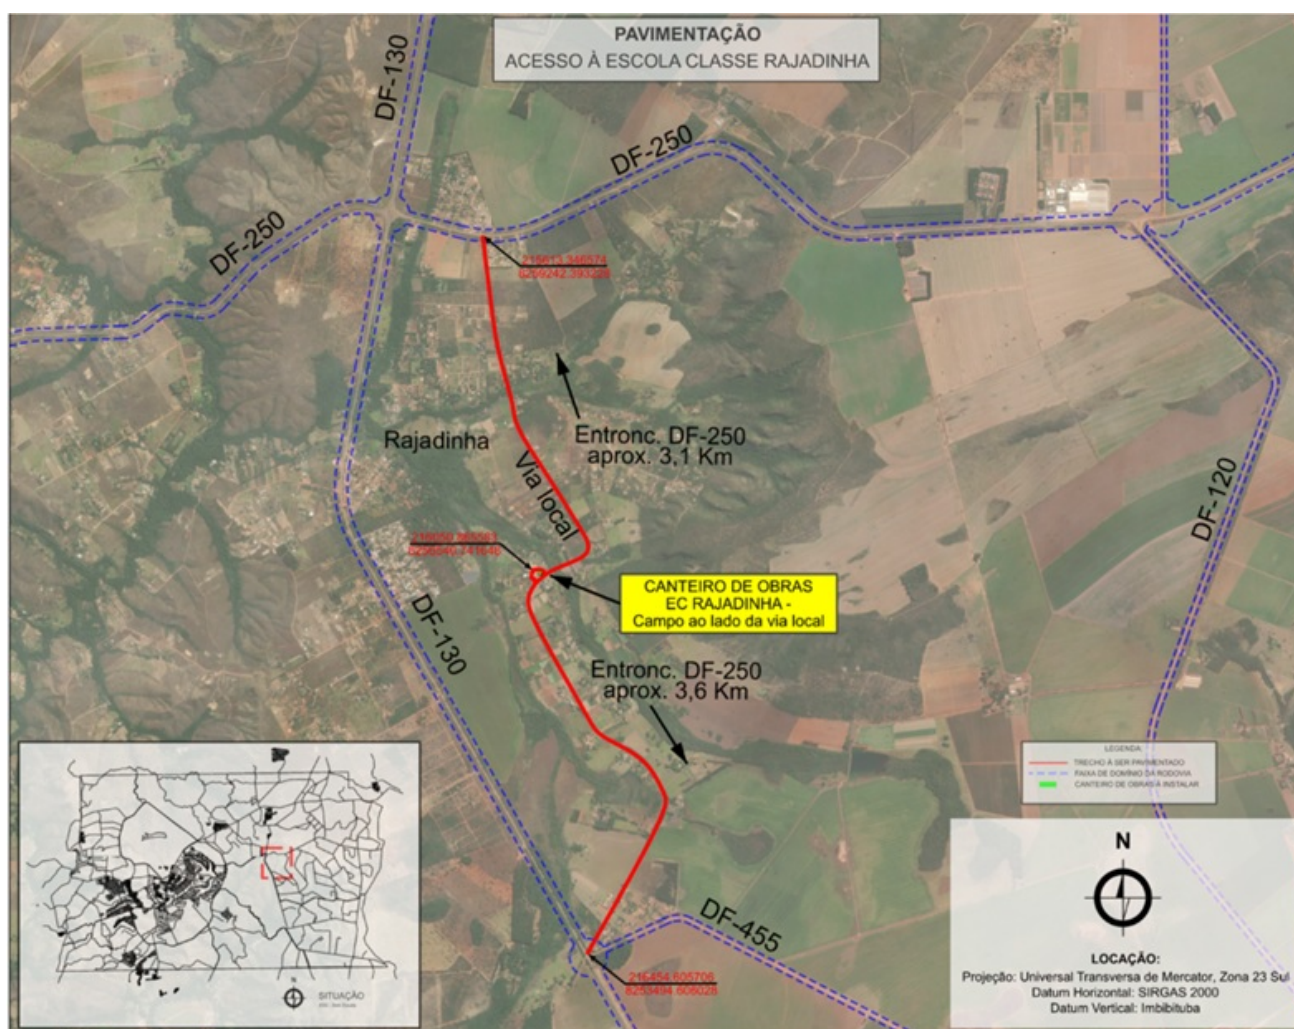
Pavimentação da Via Local (Escola Classe Rajadinha) - Segmento a ser implantado (Fonte: DER-DF)
